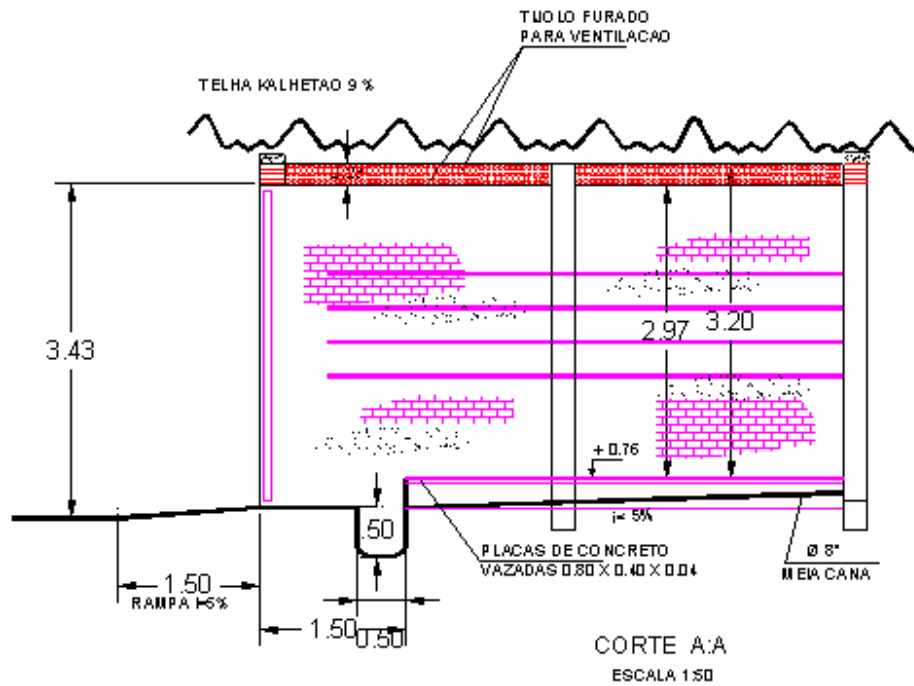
Corte AA da planta do entreposto de resíduos (PCASC, 1989).
